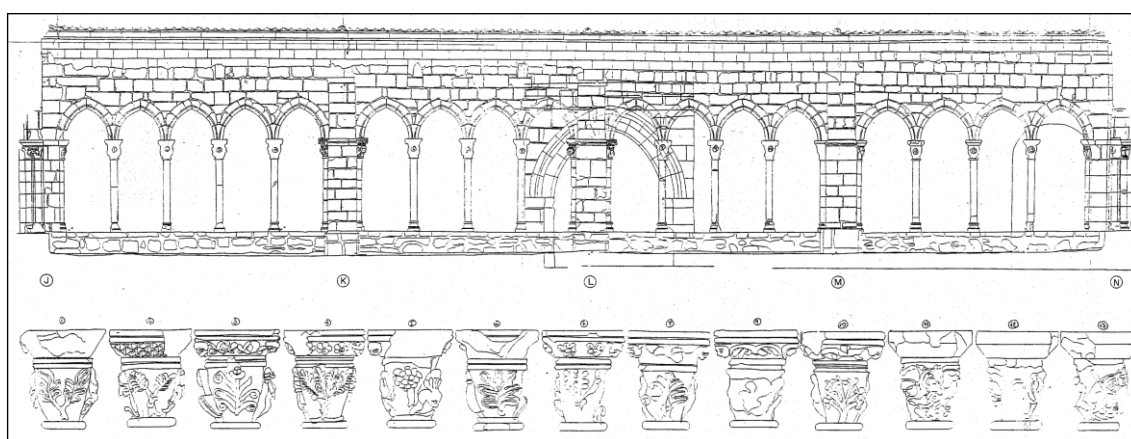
Alzado de la galería norte del claustro. E. Navarro Pallarés, 1996
